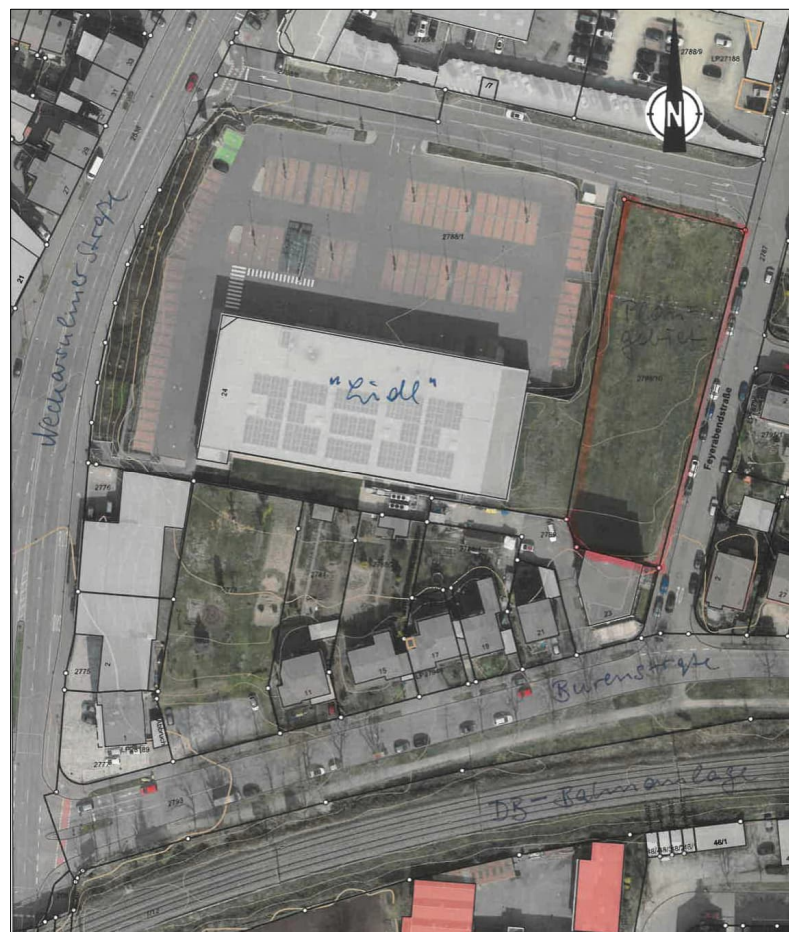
Lageplan (Plangebiet rot markiert) [34]
